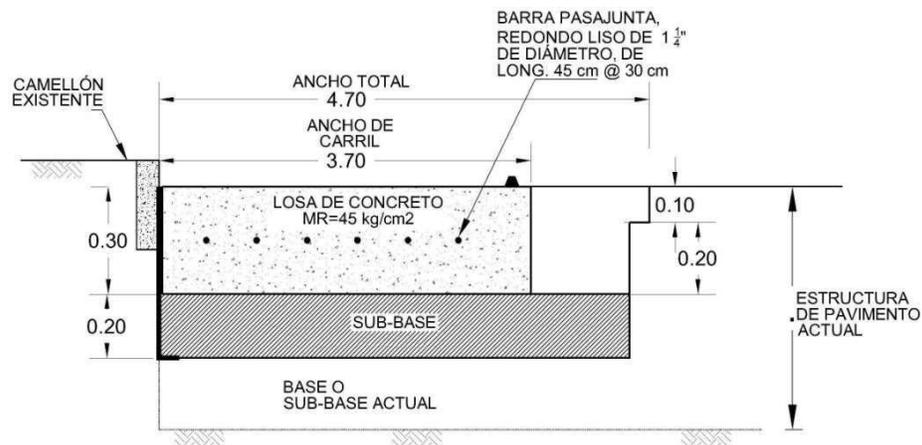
Construcción de losa de concreto hidráulico con juntas
